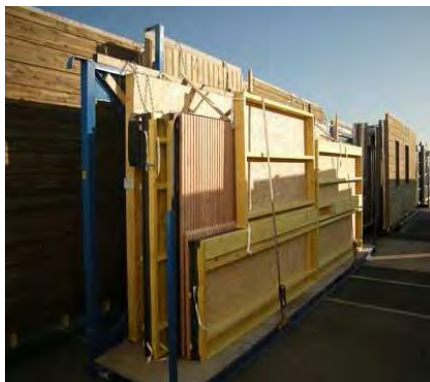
Mur ossature bois entreprise Leduc SA (44)
